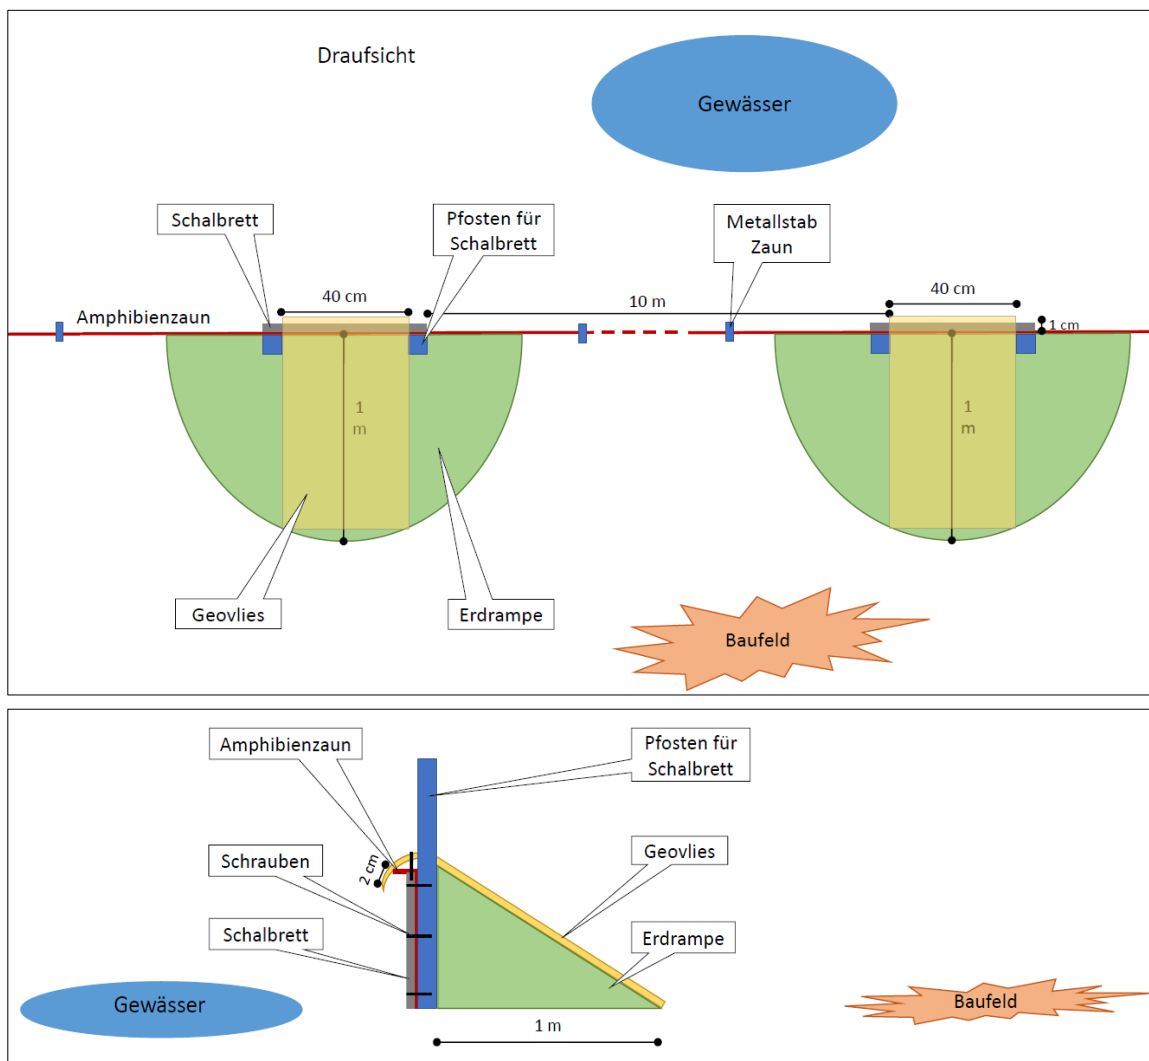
Prinzipskizze von Reusen (Oben: Draufsicht, unten: Seitenansicht)
